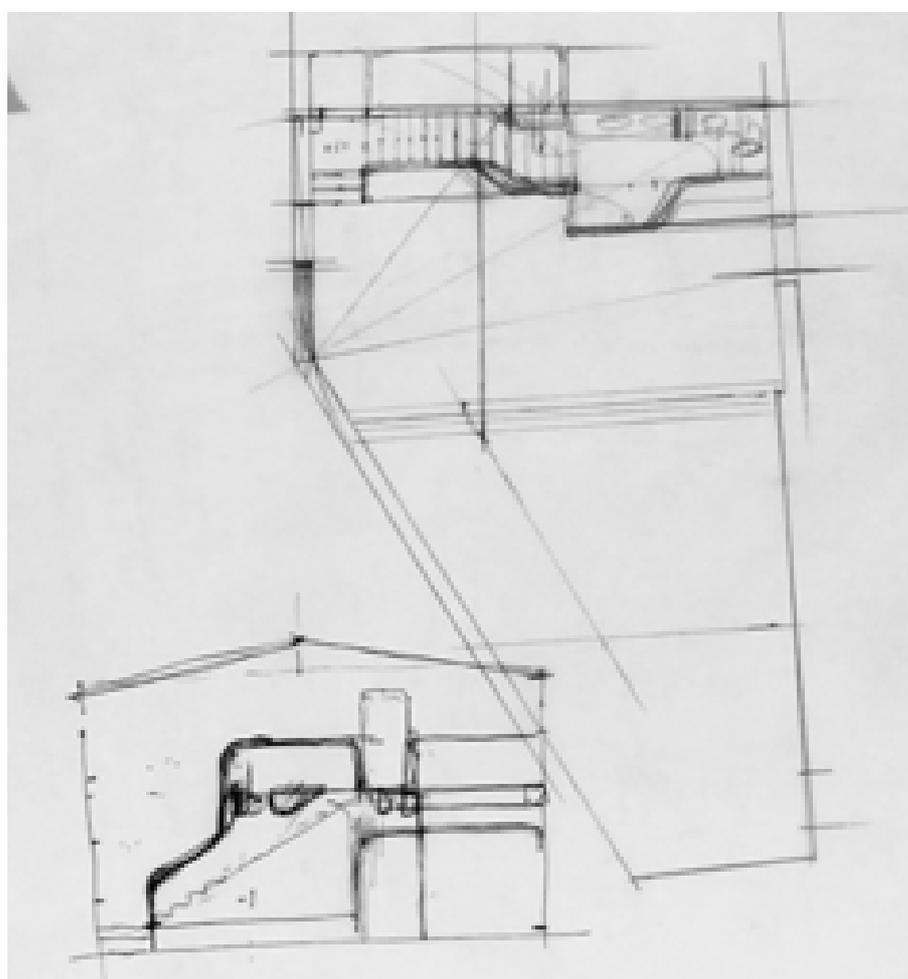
Studio pianta quota +0,00 – s.d. (AABS-94.192)
